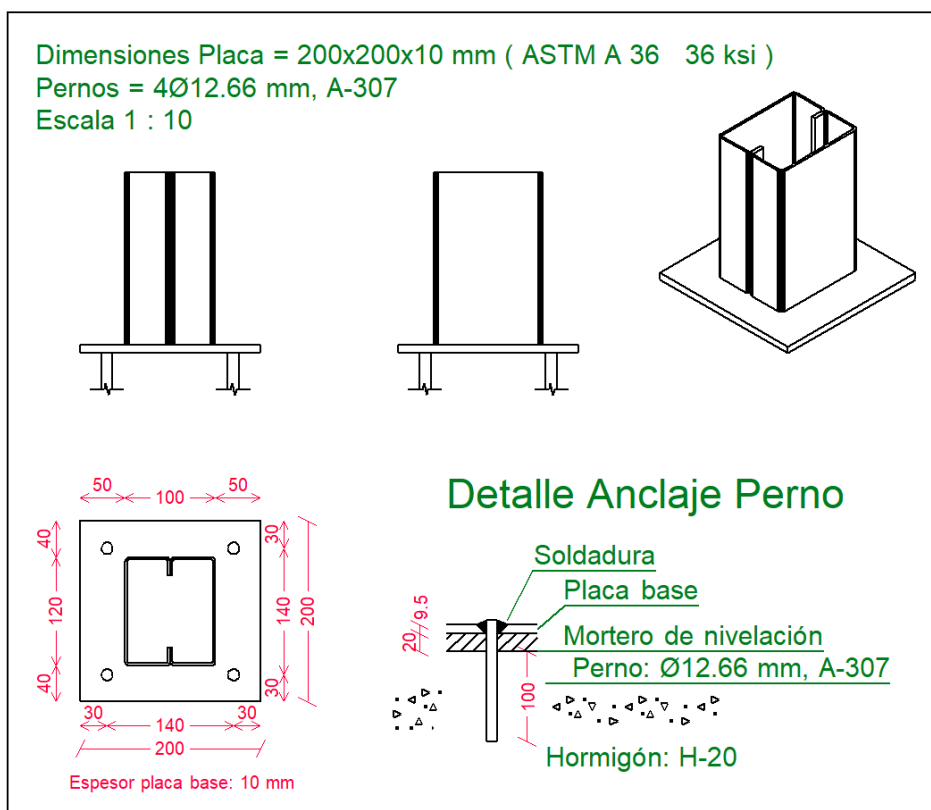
Detalle de placas de anclaje para columnas metálicas.
